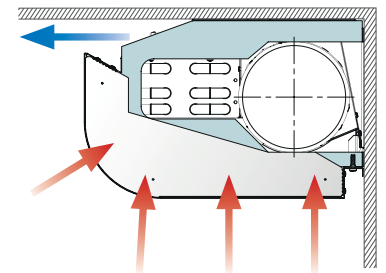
Plafond XD-FC Montage an der Wand, bündig zur Decke (FC).
